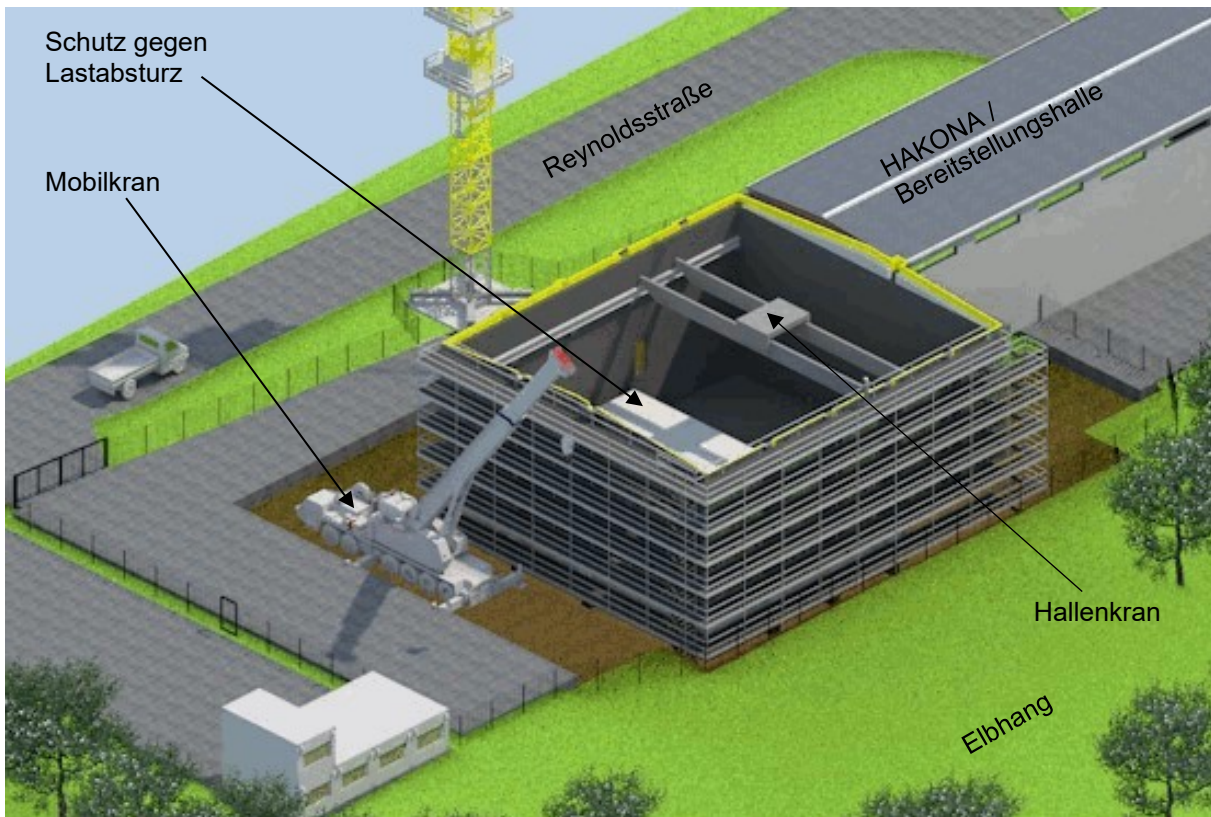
Montage Hallenkran zusammen mit den Kranbahnträgern
